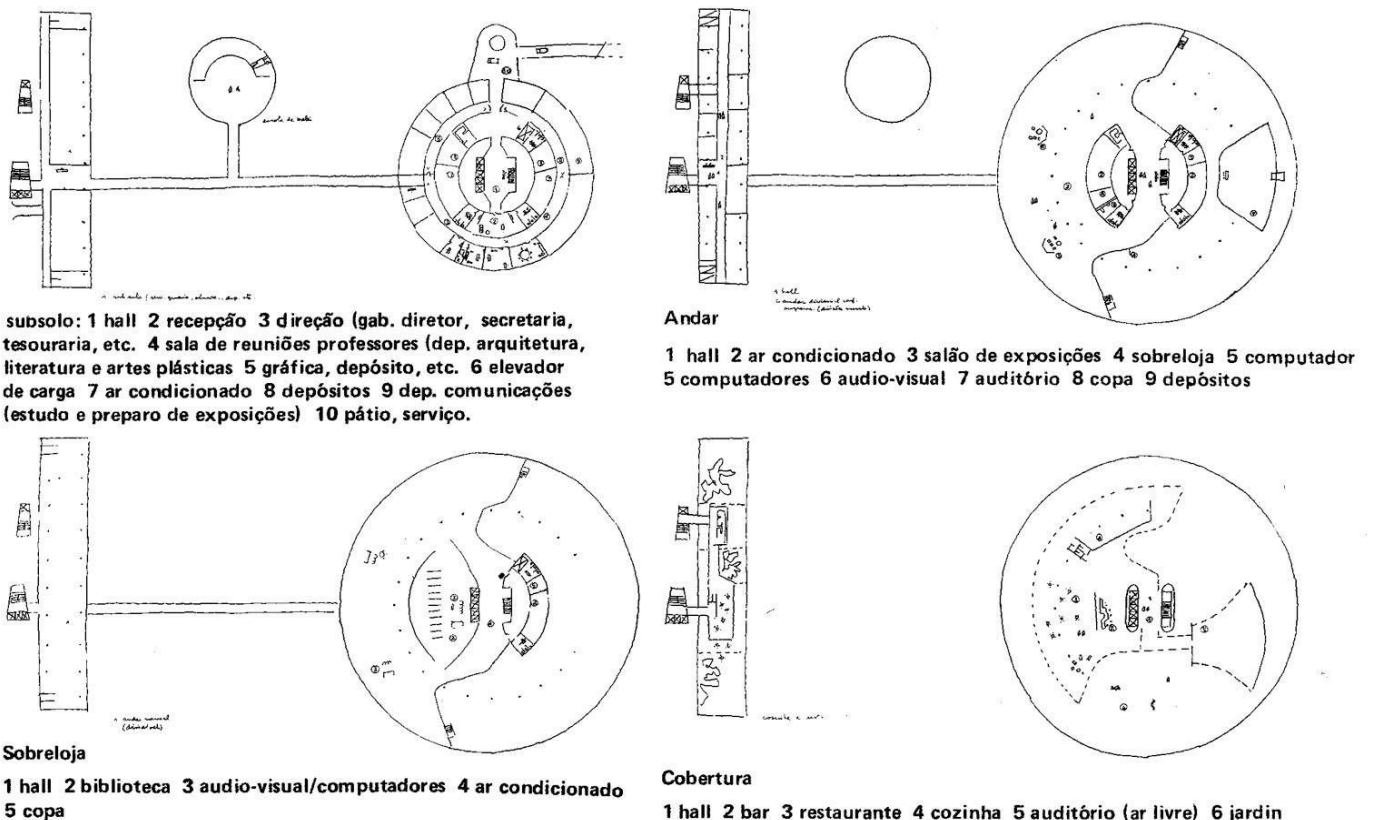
Da direita para a esquerda: planta do subsolo, planta do 1º. Piso, planta do mezanino e planta do terraço, 1986. Fonte: Módulo, 1986.
